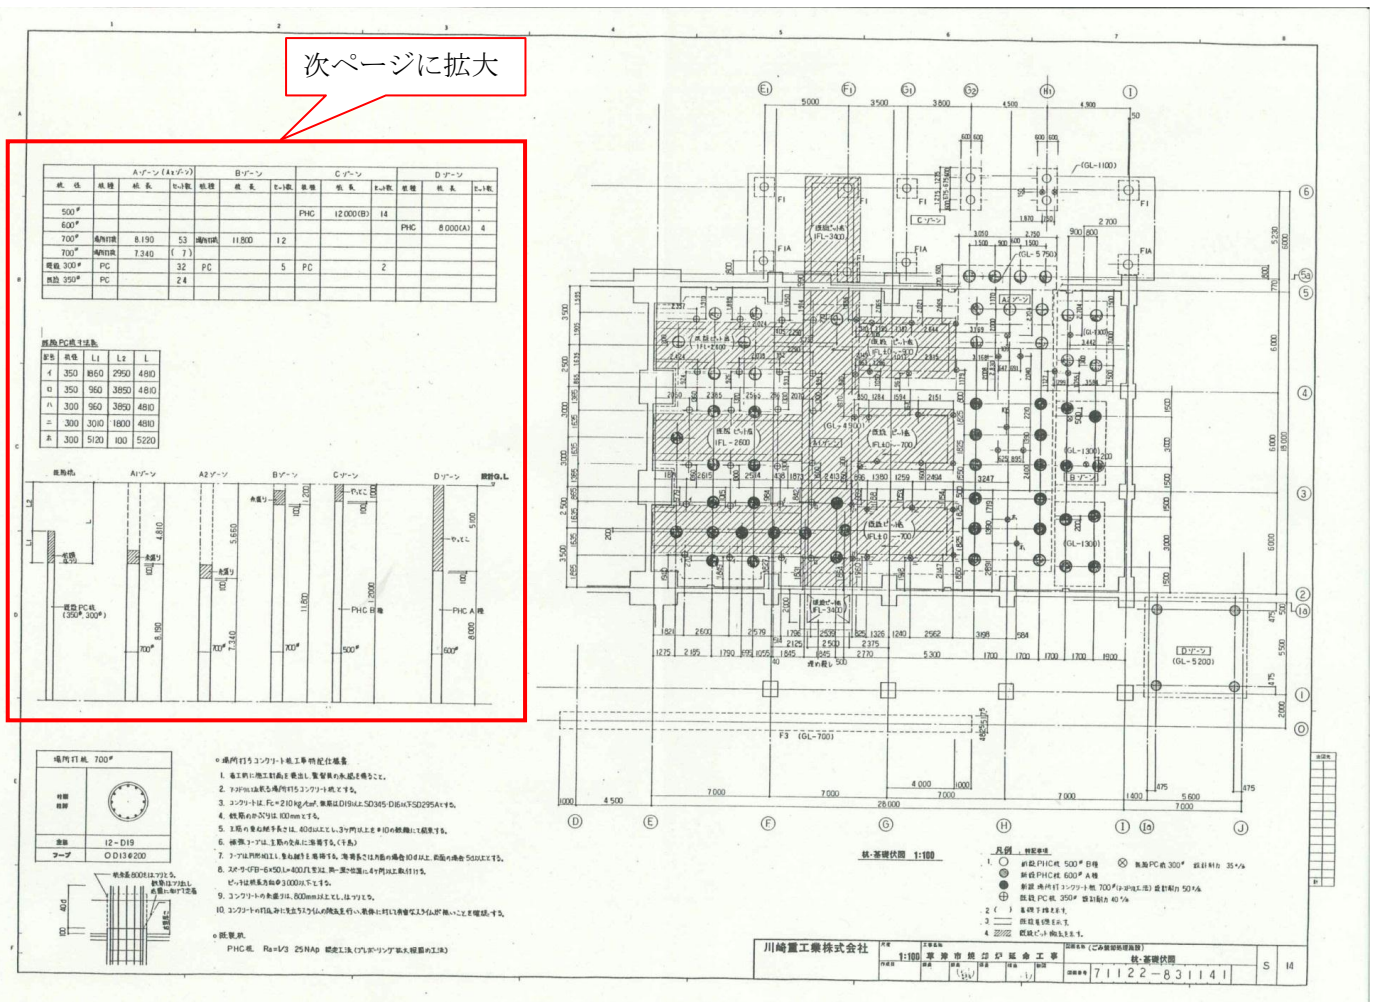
既存ごみ焼却施設の杭・基礎平面配置図
